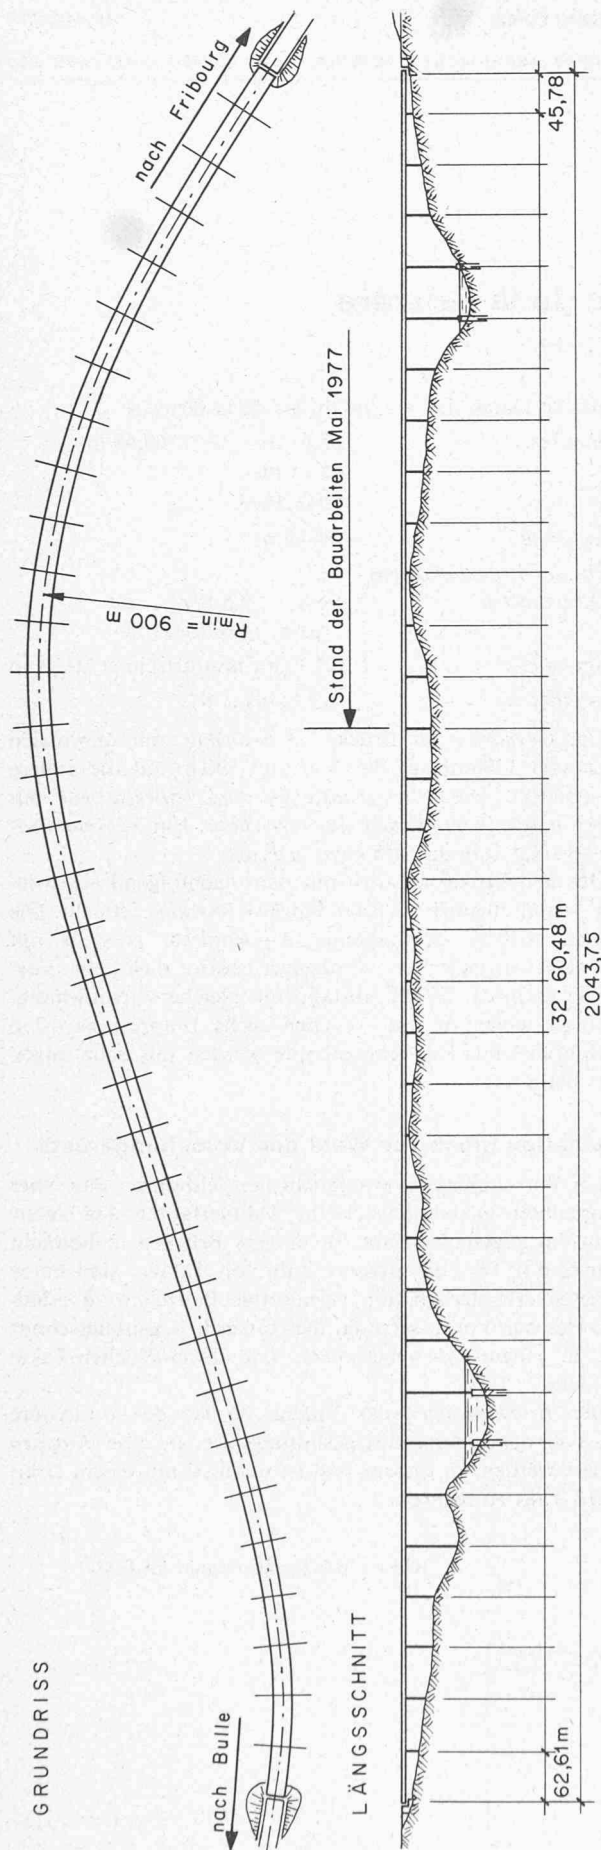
Längsschnitt und Grundriss der Brücke
